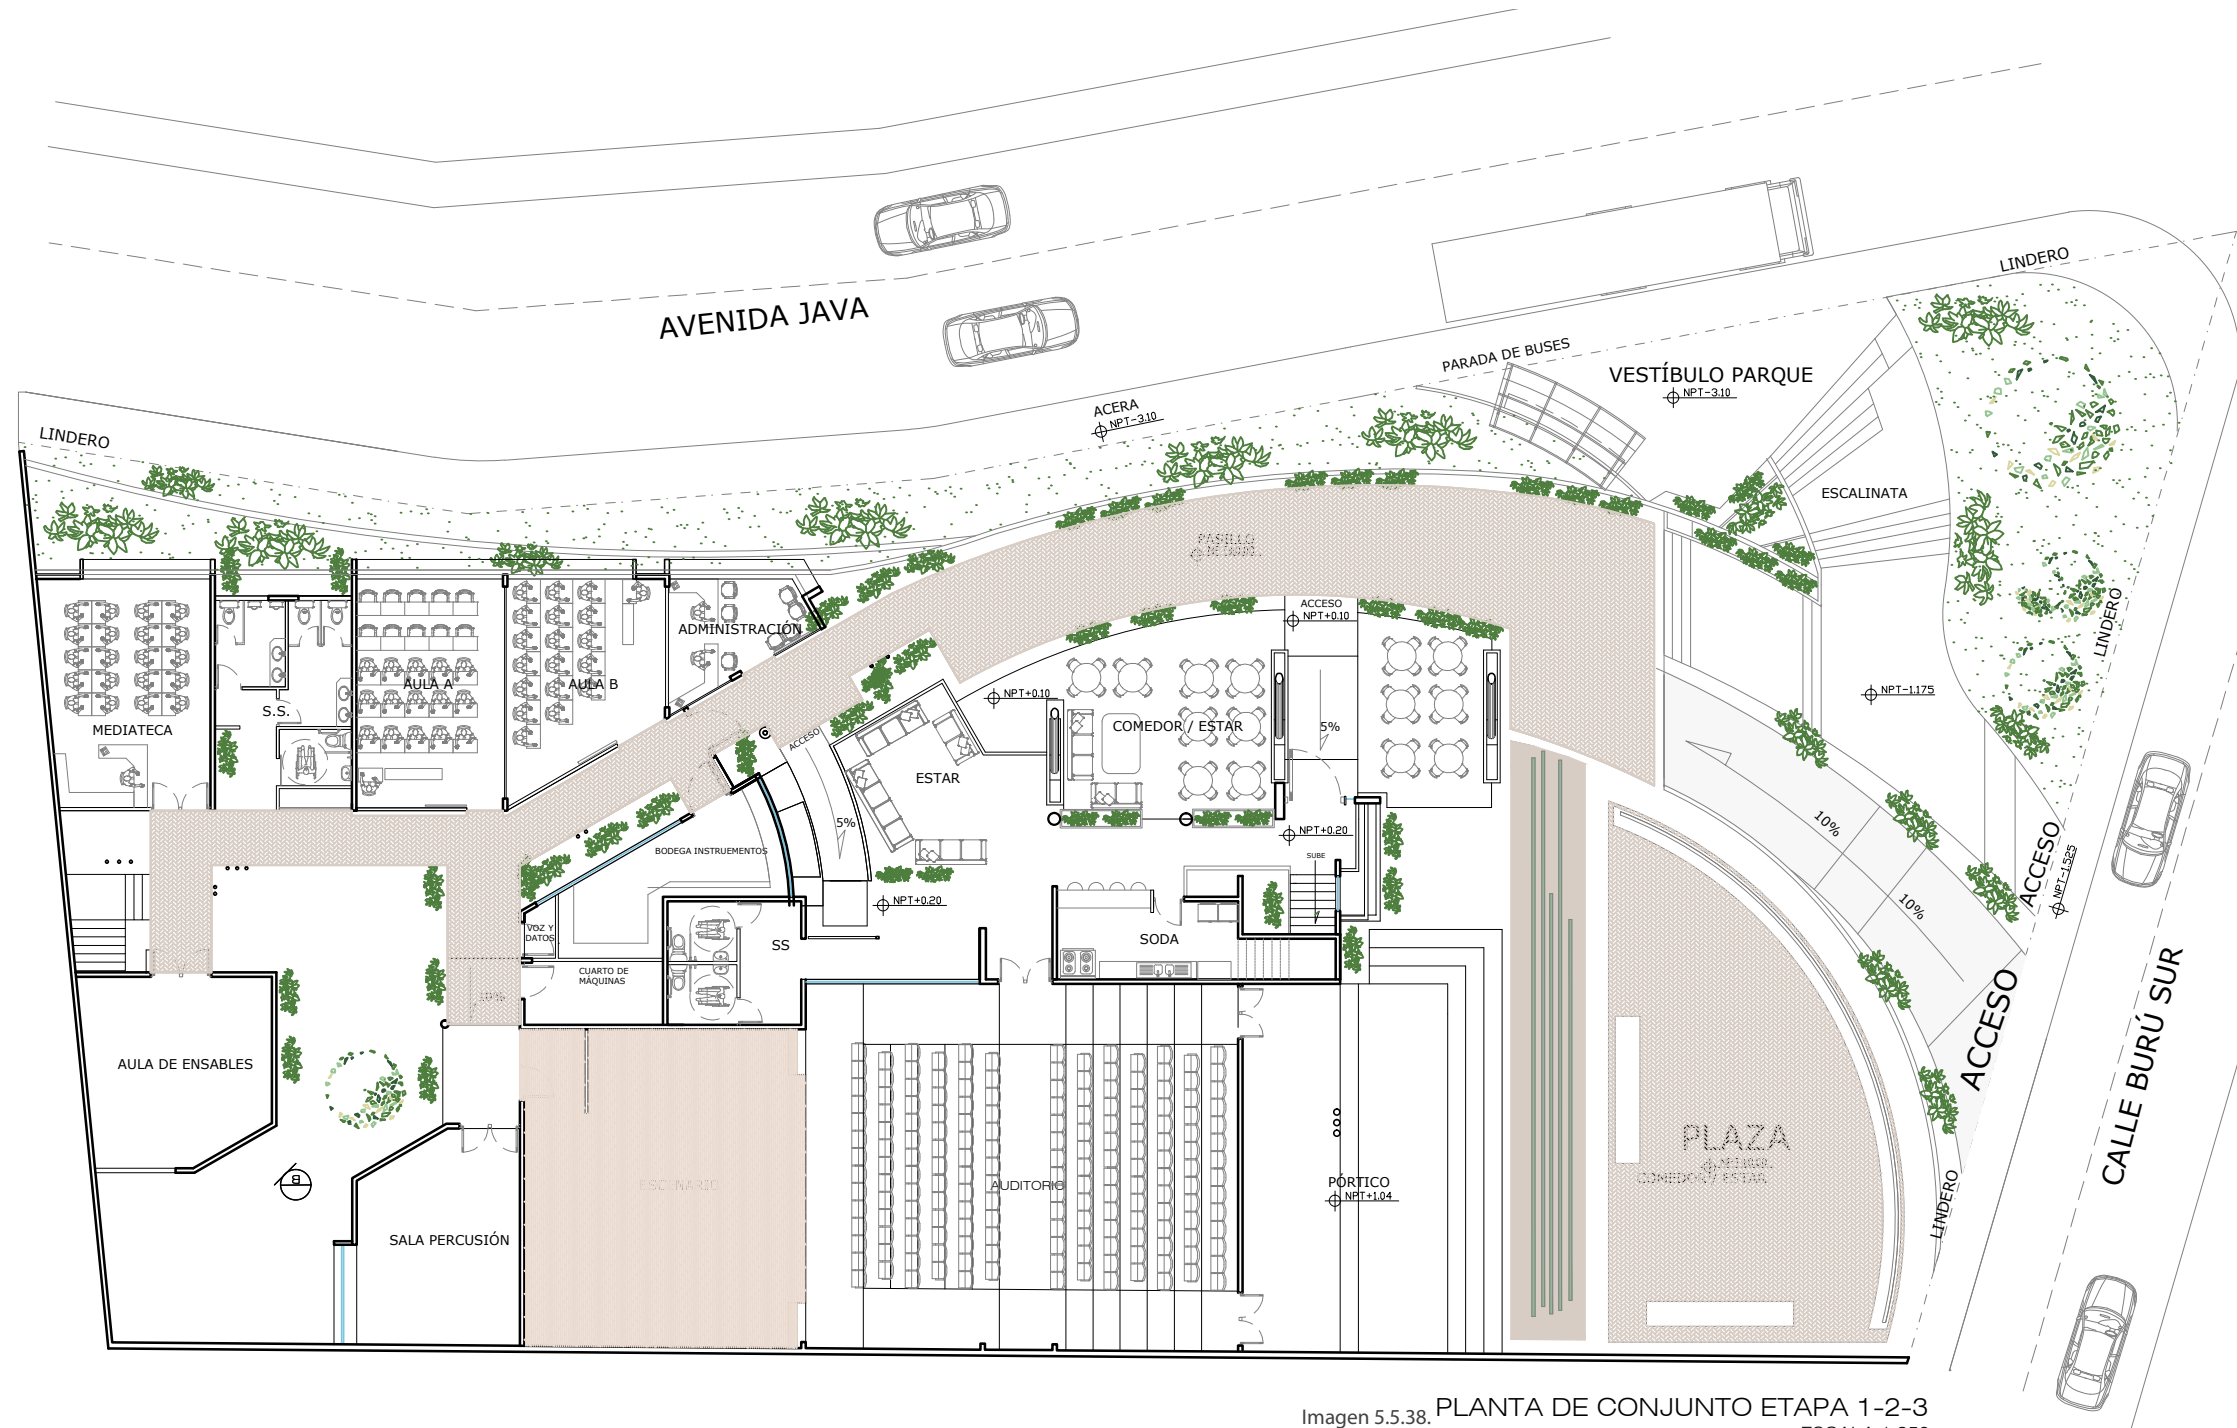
PLANTA DE CONJUNTO ETAPA 1-2-3
